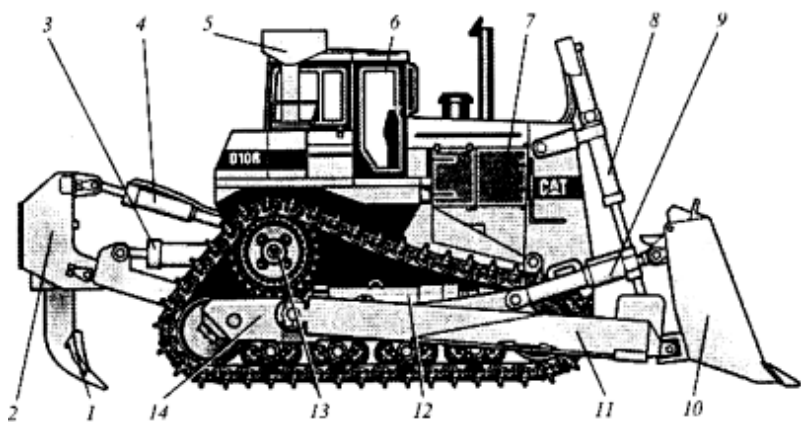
Гусеничный бульдозерно-рыхлительный агрегат:
